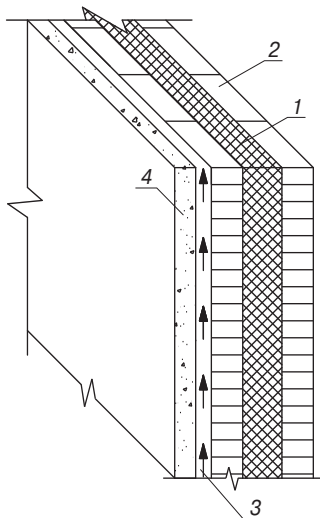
Стеновая система с защитно-декоративным экраном: 1 – утеплитель; 2 – кладка из мелкоштучных материалов (блоки из ячеистого бетона или кирпич); 3 – воздушная прослойка; 4 – железобетонный экран
